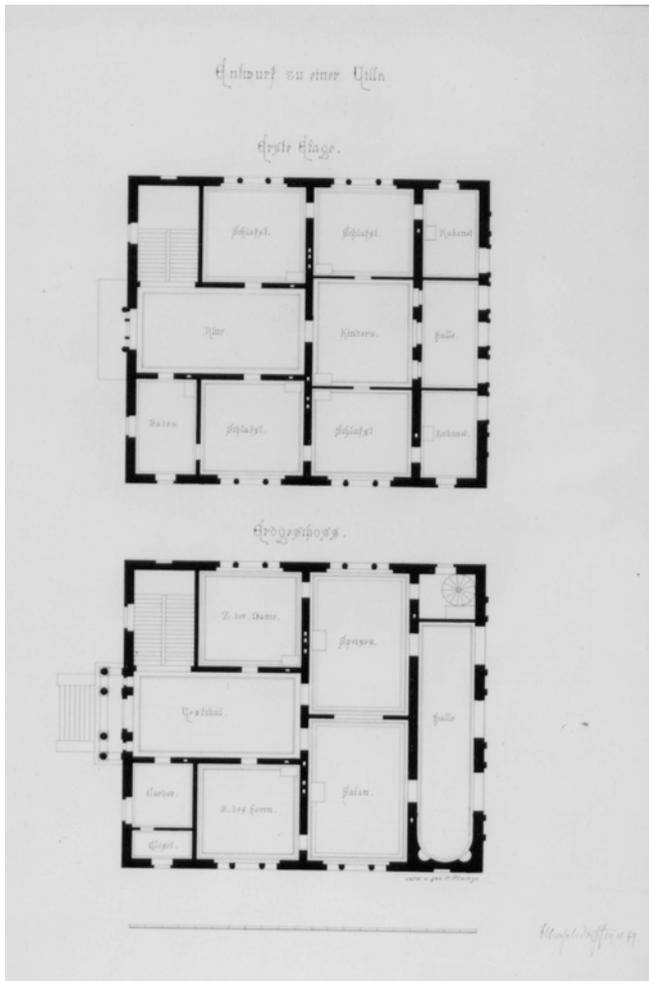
Heinrich Plange, Entwurf zu einer Villa, Grundriss Erste Etage (oben) und Erdgeschoss (unten), 1879
